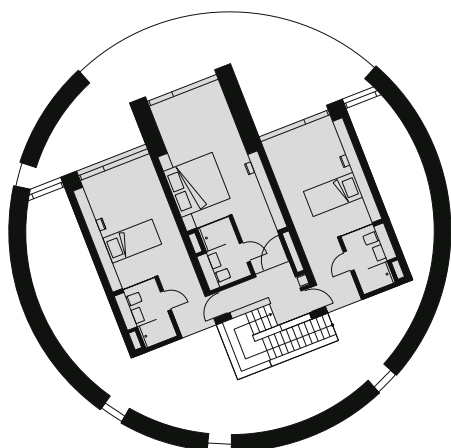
Plans et élévations sommaires de la maison GUTECH-Ecohouse a Muscat.
